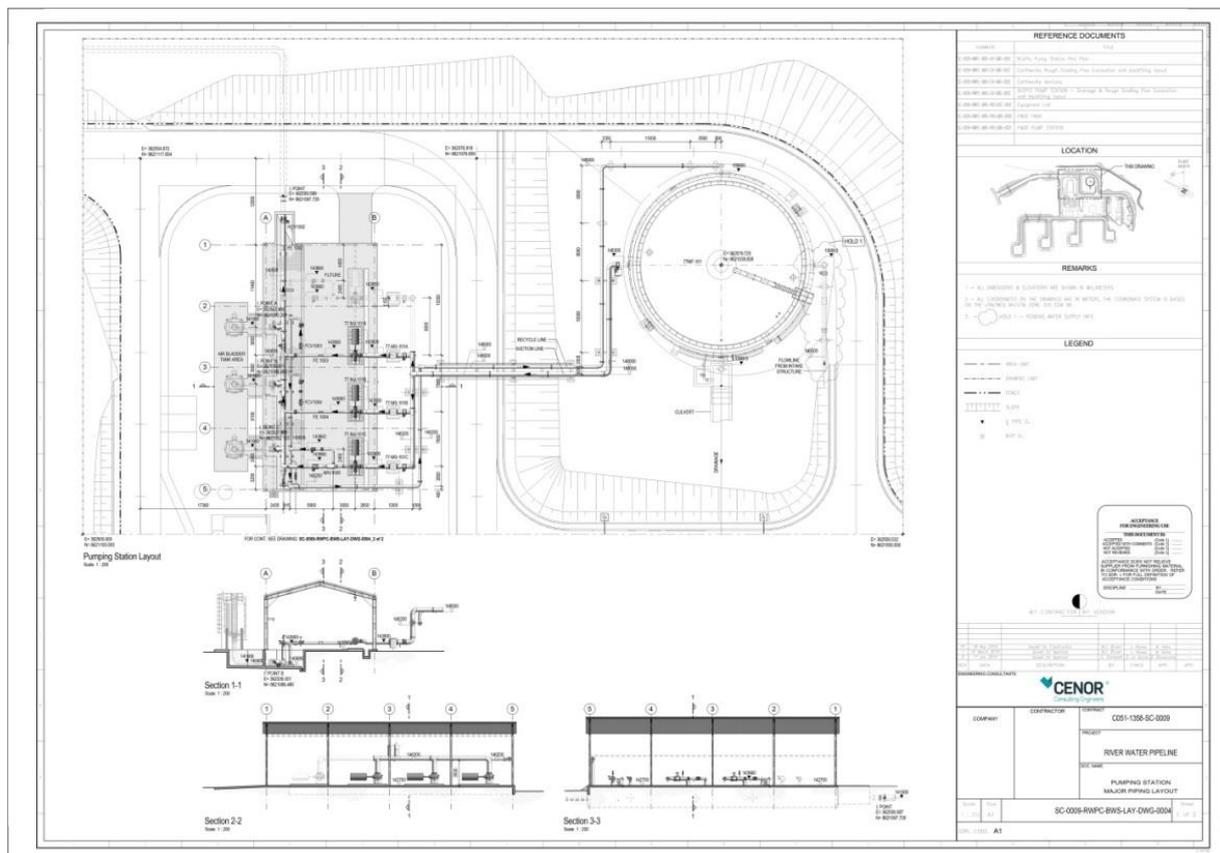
Folha de projeto – planta e cortes da estação elevatória.
